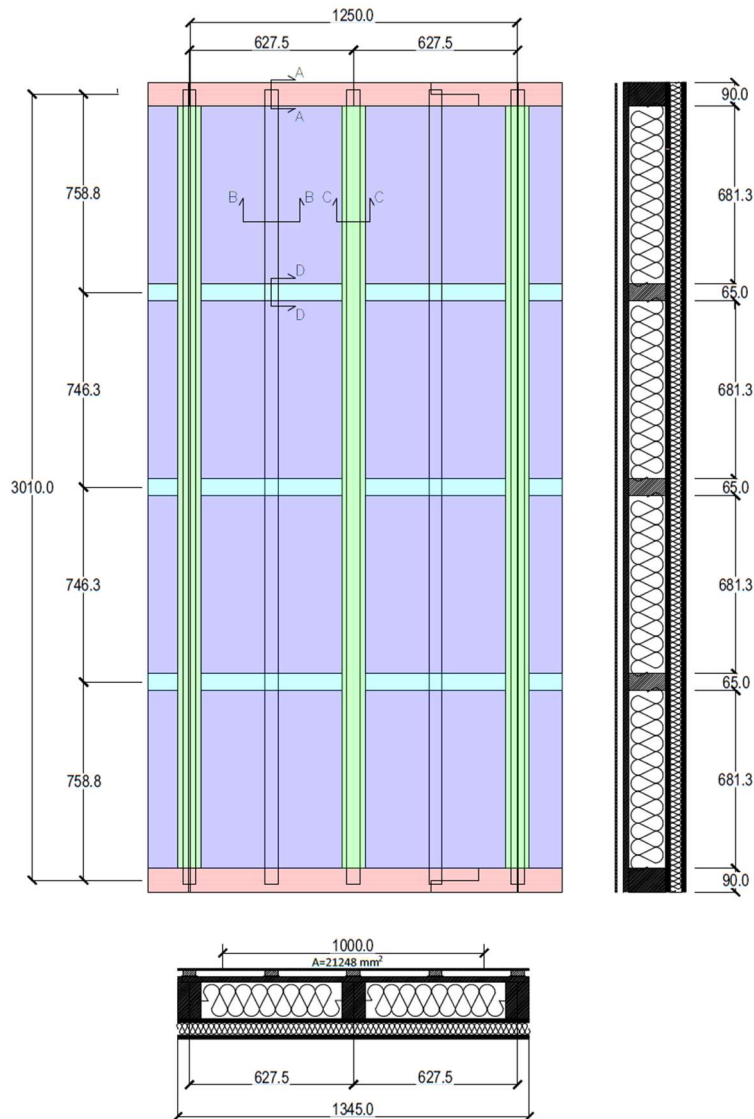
Vista frontal, sección horizontal y sección vertical del módulo de fachada
